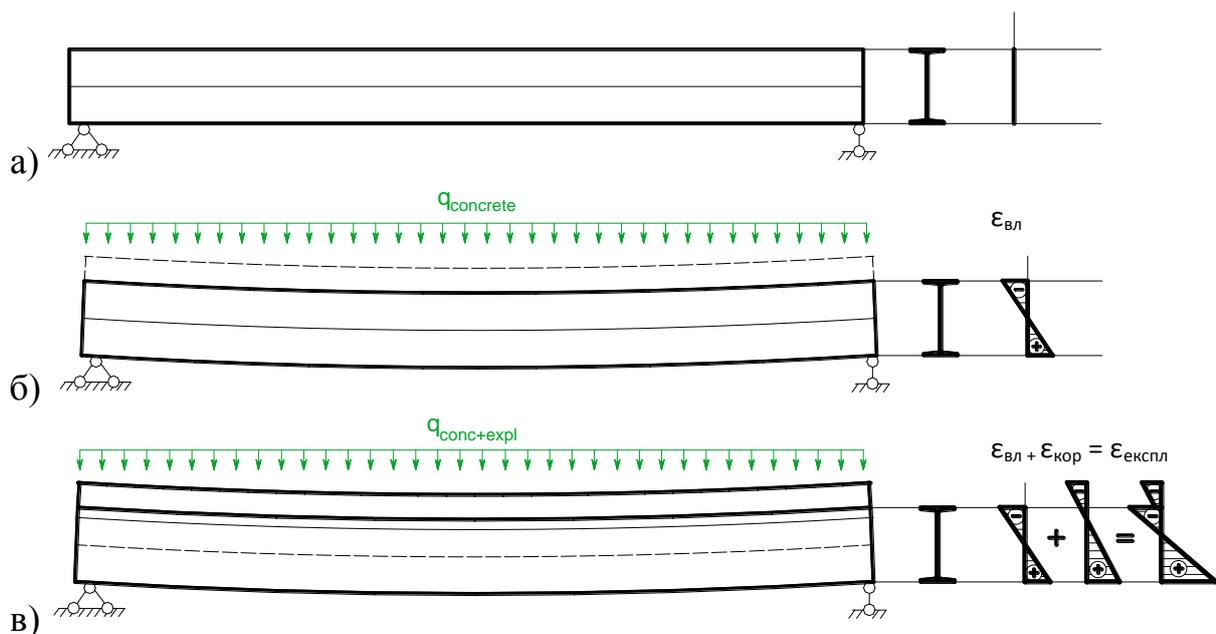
Стадії роботи комбінованого сталезалізобетонного перекриття, виготовленого за двостадійною технологією: а) монтаж сталевих балок; б) влаштування монолітної плити перекриття; в) експлуатаційна стадія
